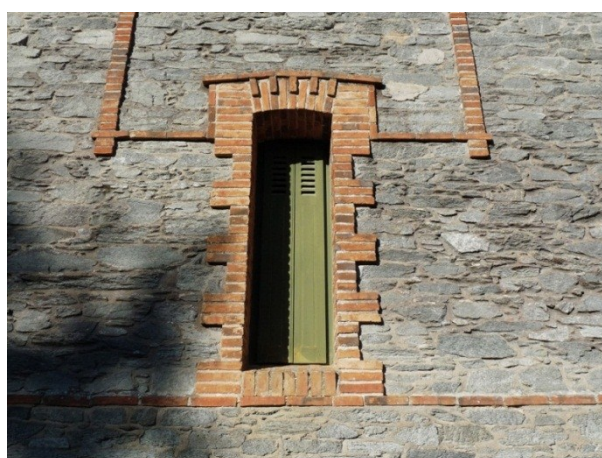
Mur de façade d'une maison en pierre²²
